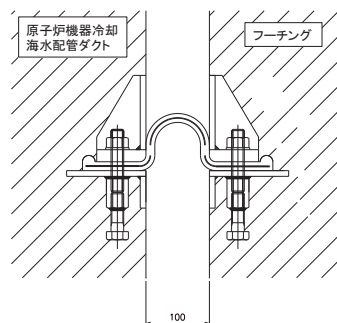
(4) 止水ライン③の構造概要 (Ω型ジョイント施工イメージ (平面図))
